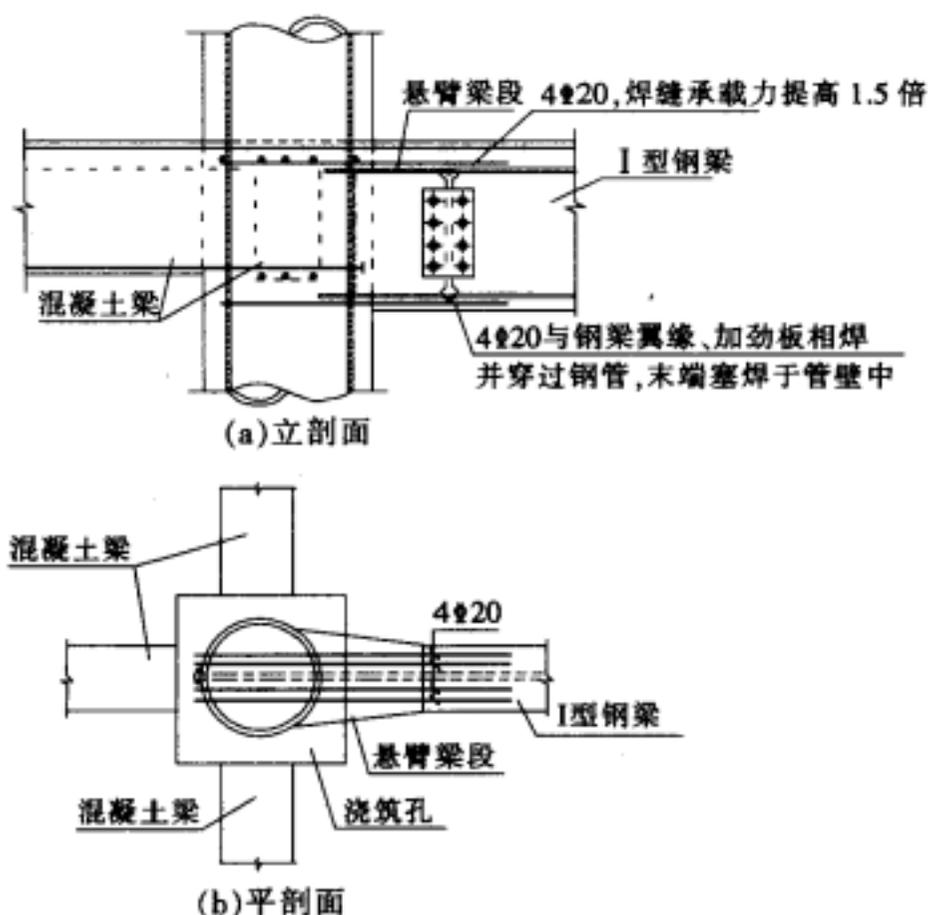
一根钢骨混凝土梁与钢管混凝土叠合柱连接节点构造
